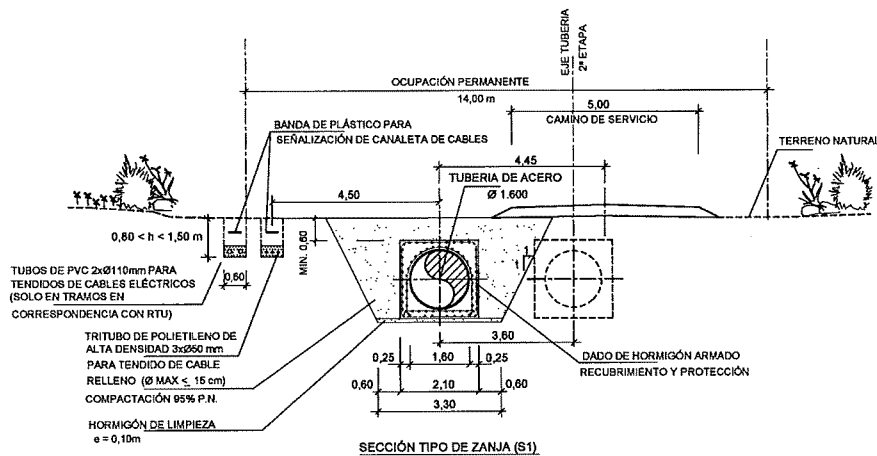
Sección tipo en zanja con dado de hormigón (RB.3)
